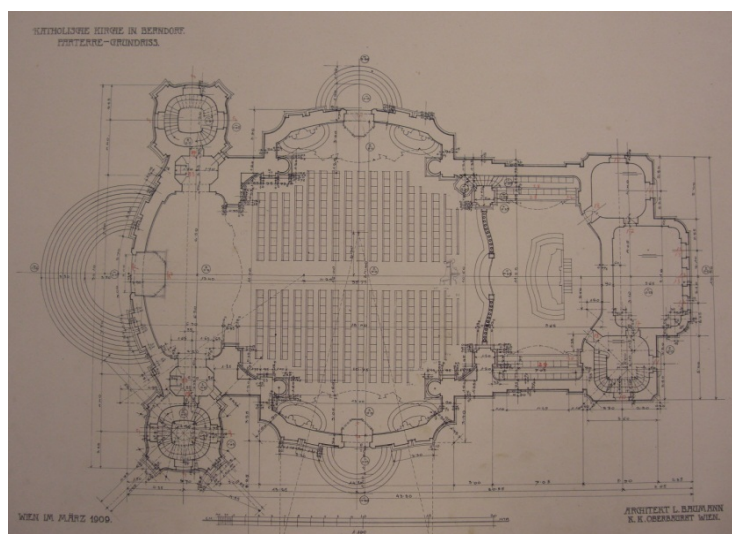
Grundriss Erdgeschoß Kirche
